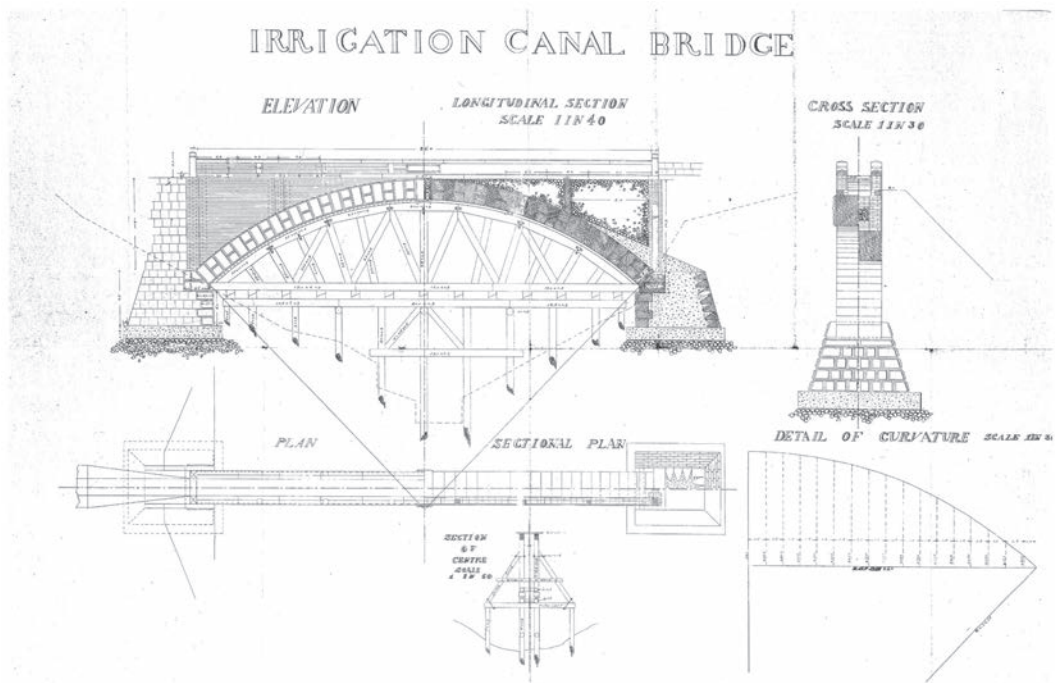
当初の設計図『IRRIGATION CANAL BRIDGE』
